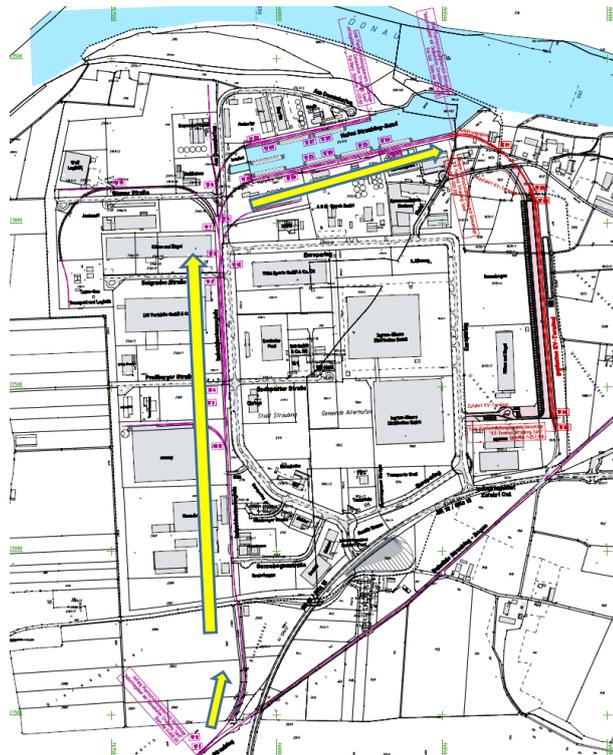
Zuführung über Hafengleis - Plan 2469_A02_3_Ü2c_Übersichtslageplan_5000
